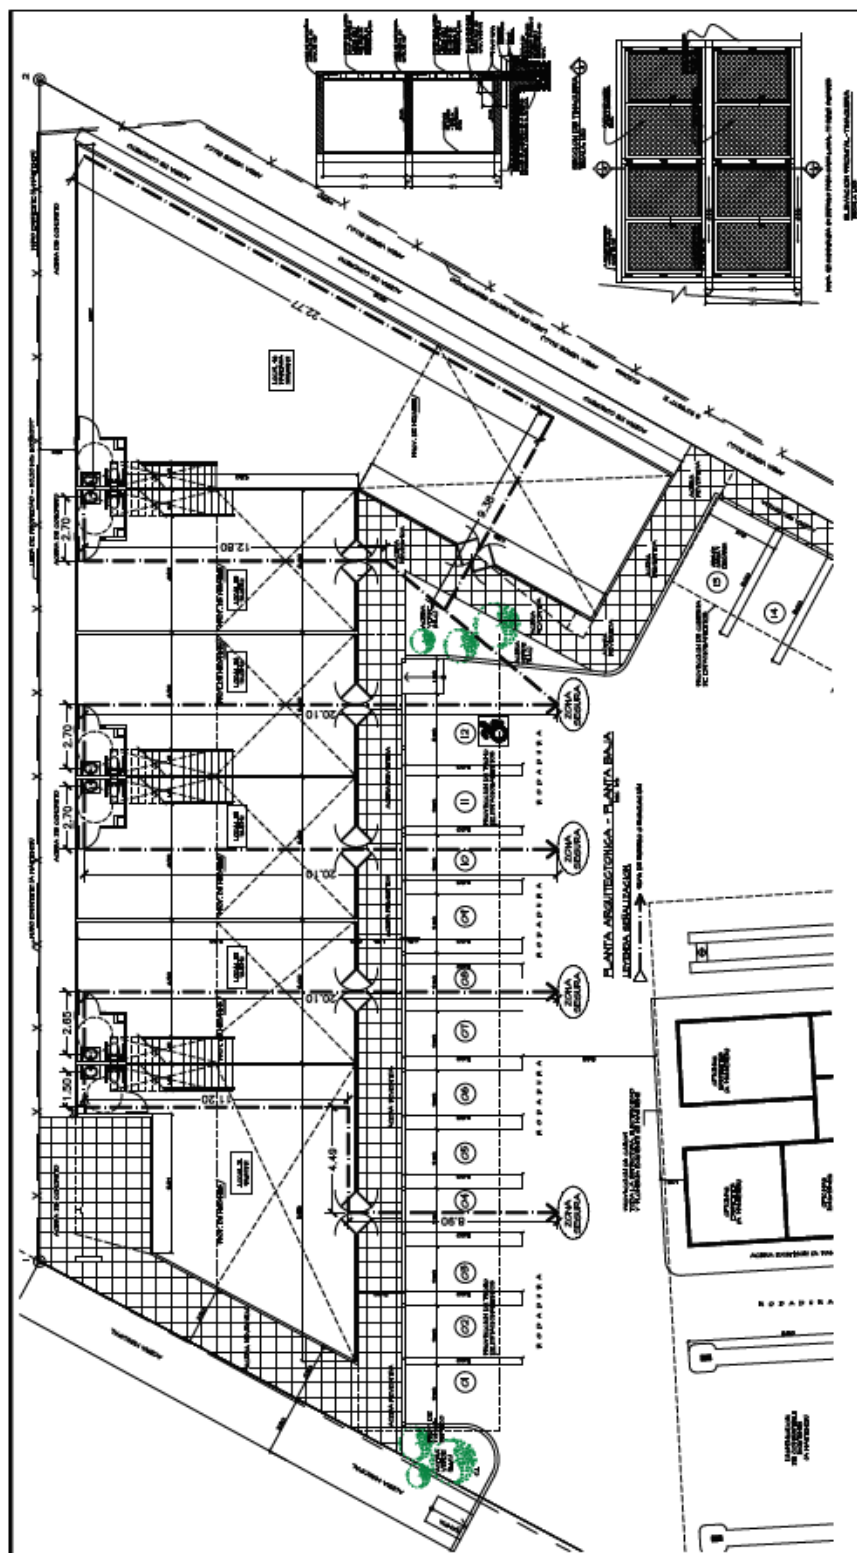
Planta Arquitectónica, Planta - baja del Proyecto
